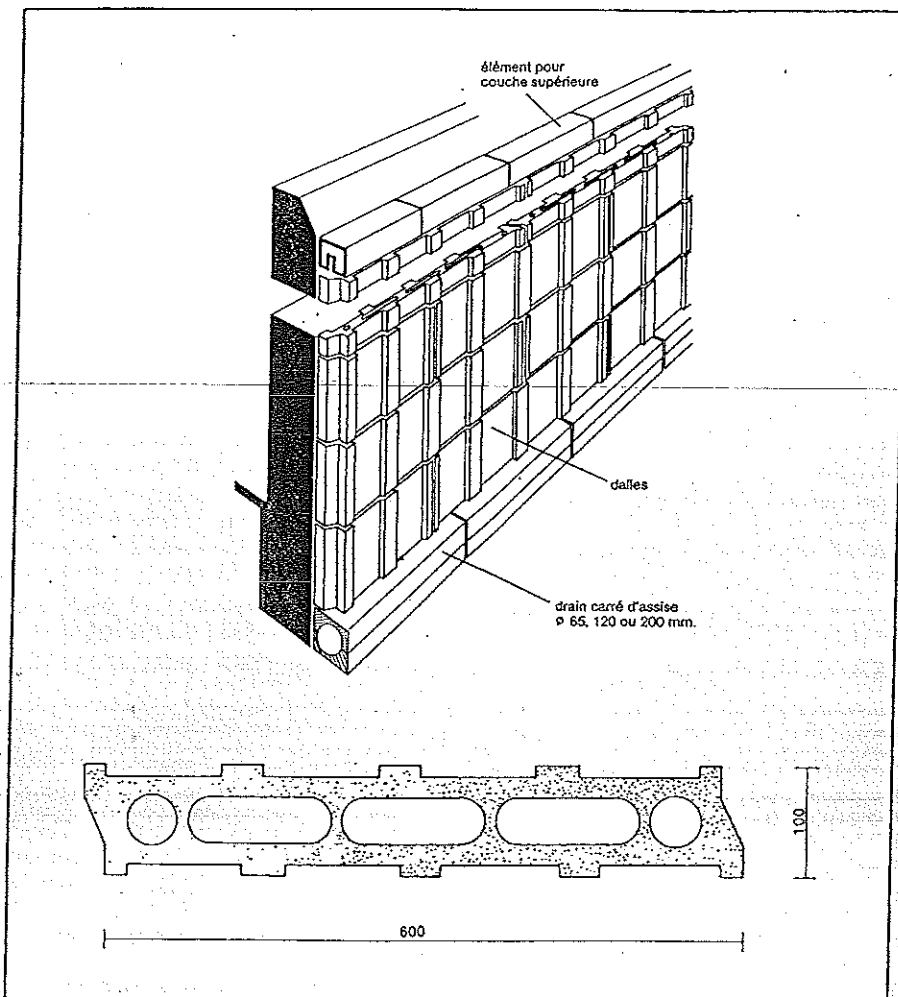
Protection des murs enterrés par empilage d'éléments en béton poreux. Perspective et coupe d'un élément.
